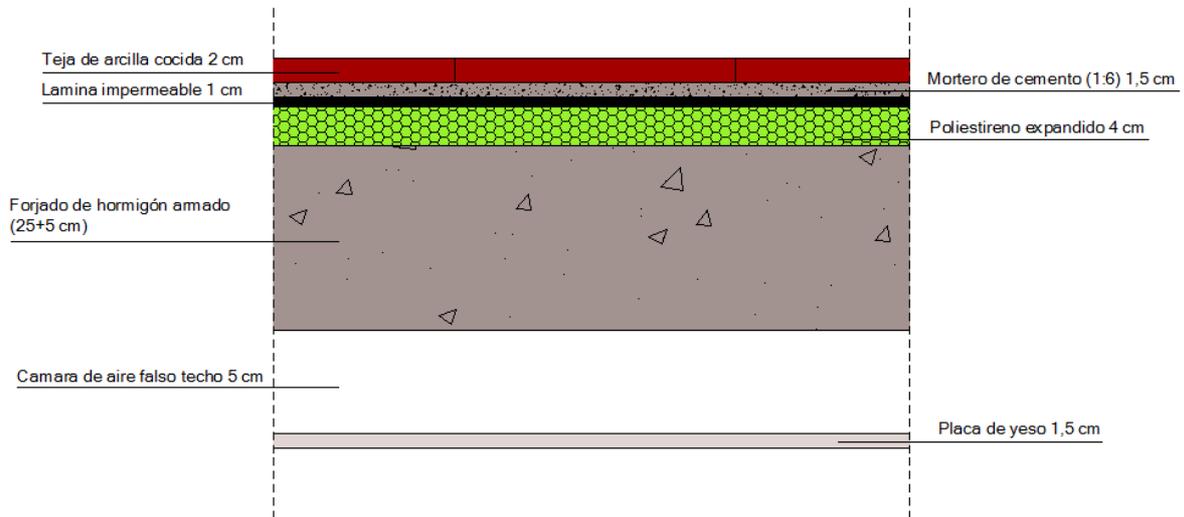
Detalle cubierta tipo 1 falso techo.2014.CAD.
